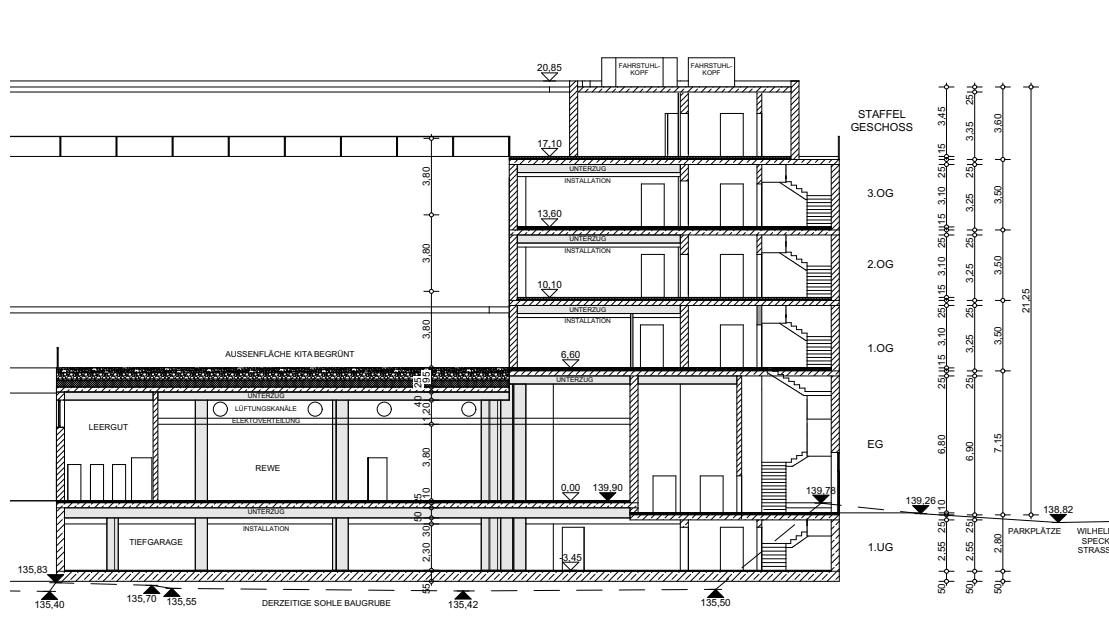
Systemschnitt – Neubau eines REWE-Marktes (erstellt: Büro Stiebing Architektur)
